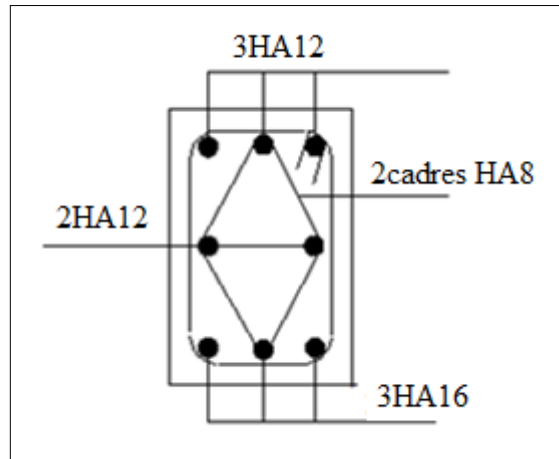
Schéma de ferrailage de poutre palière type 2-2
